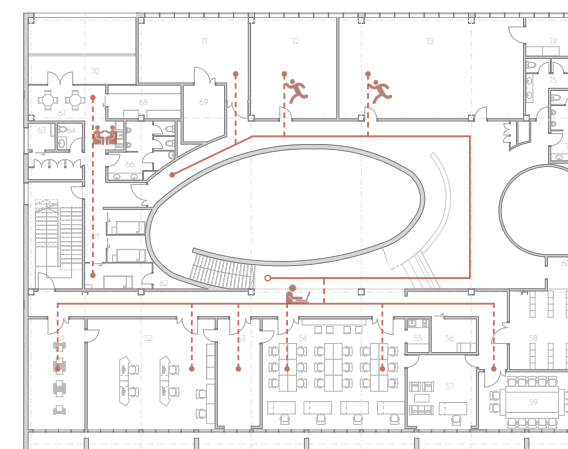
Esquema circulaciones Primera Planta Alta. (Autoras, 2019)
